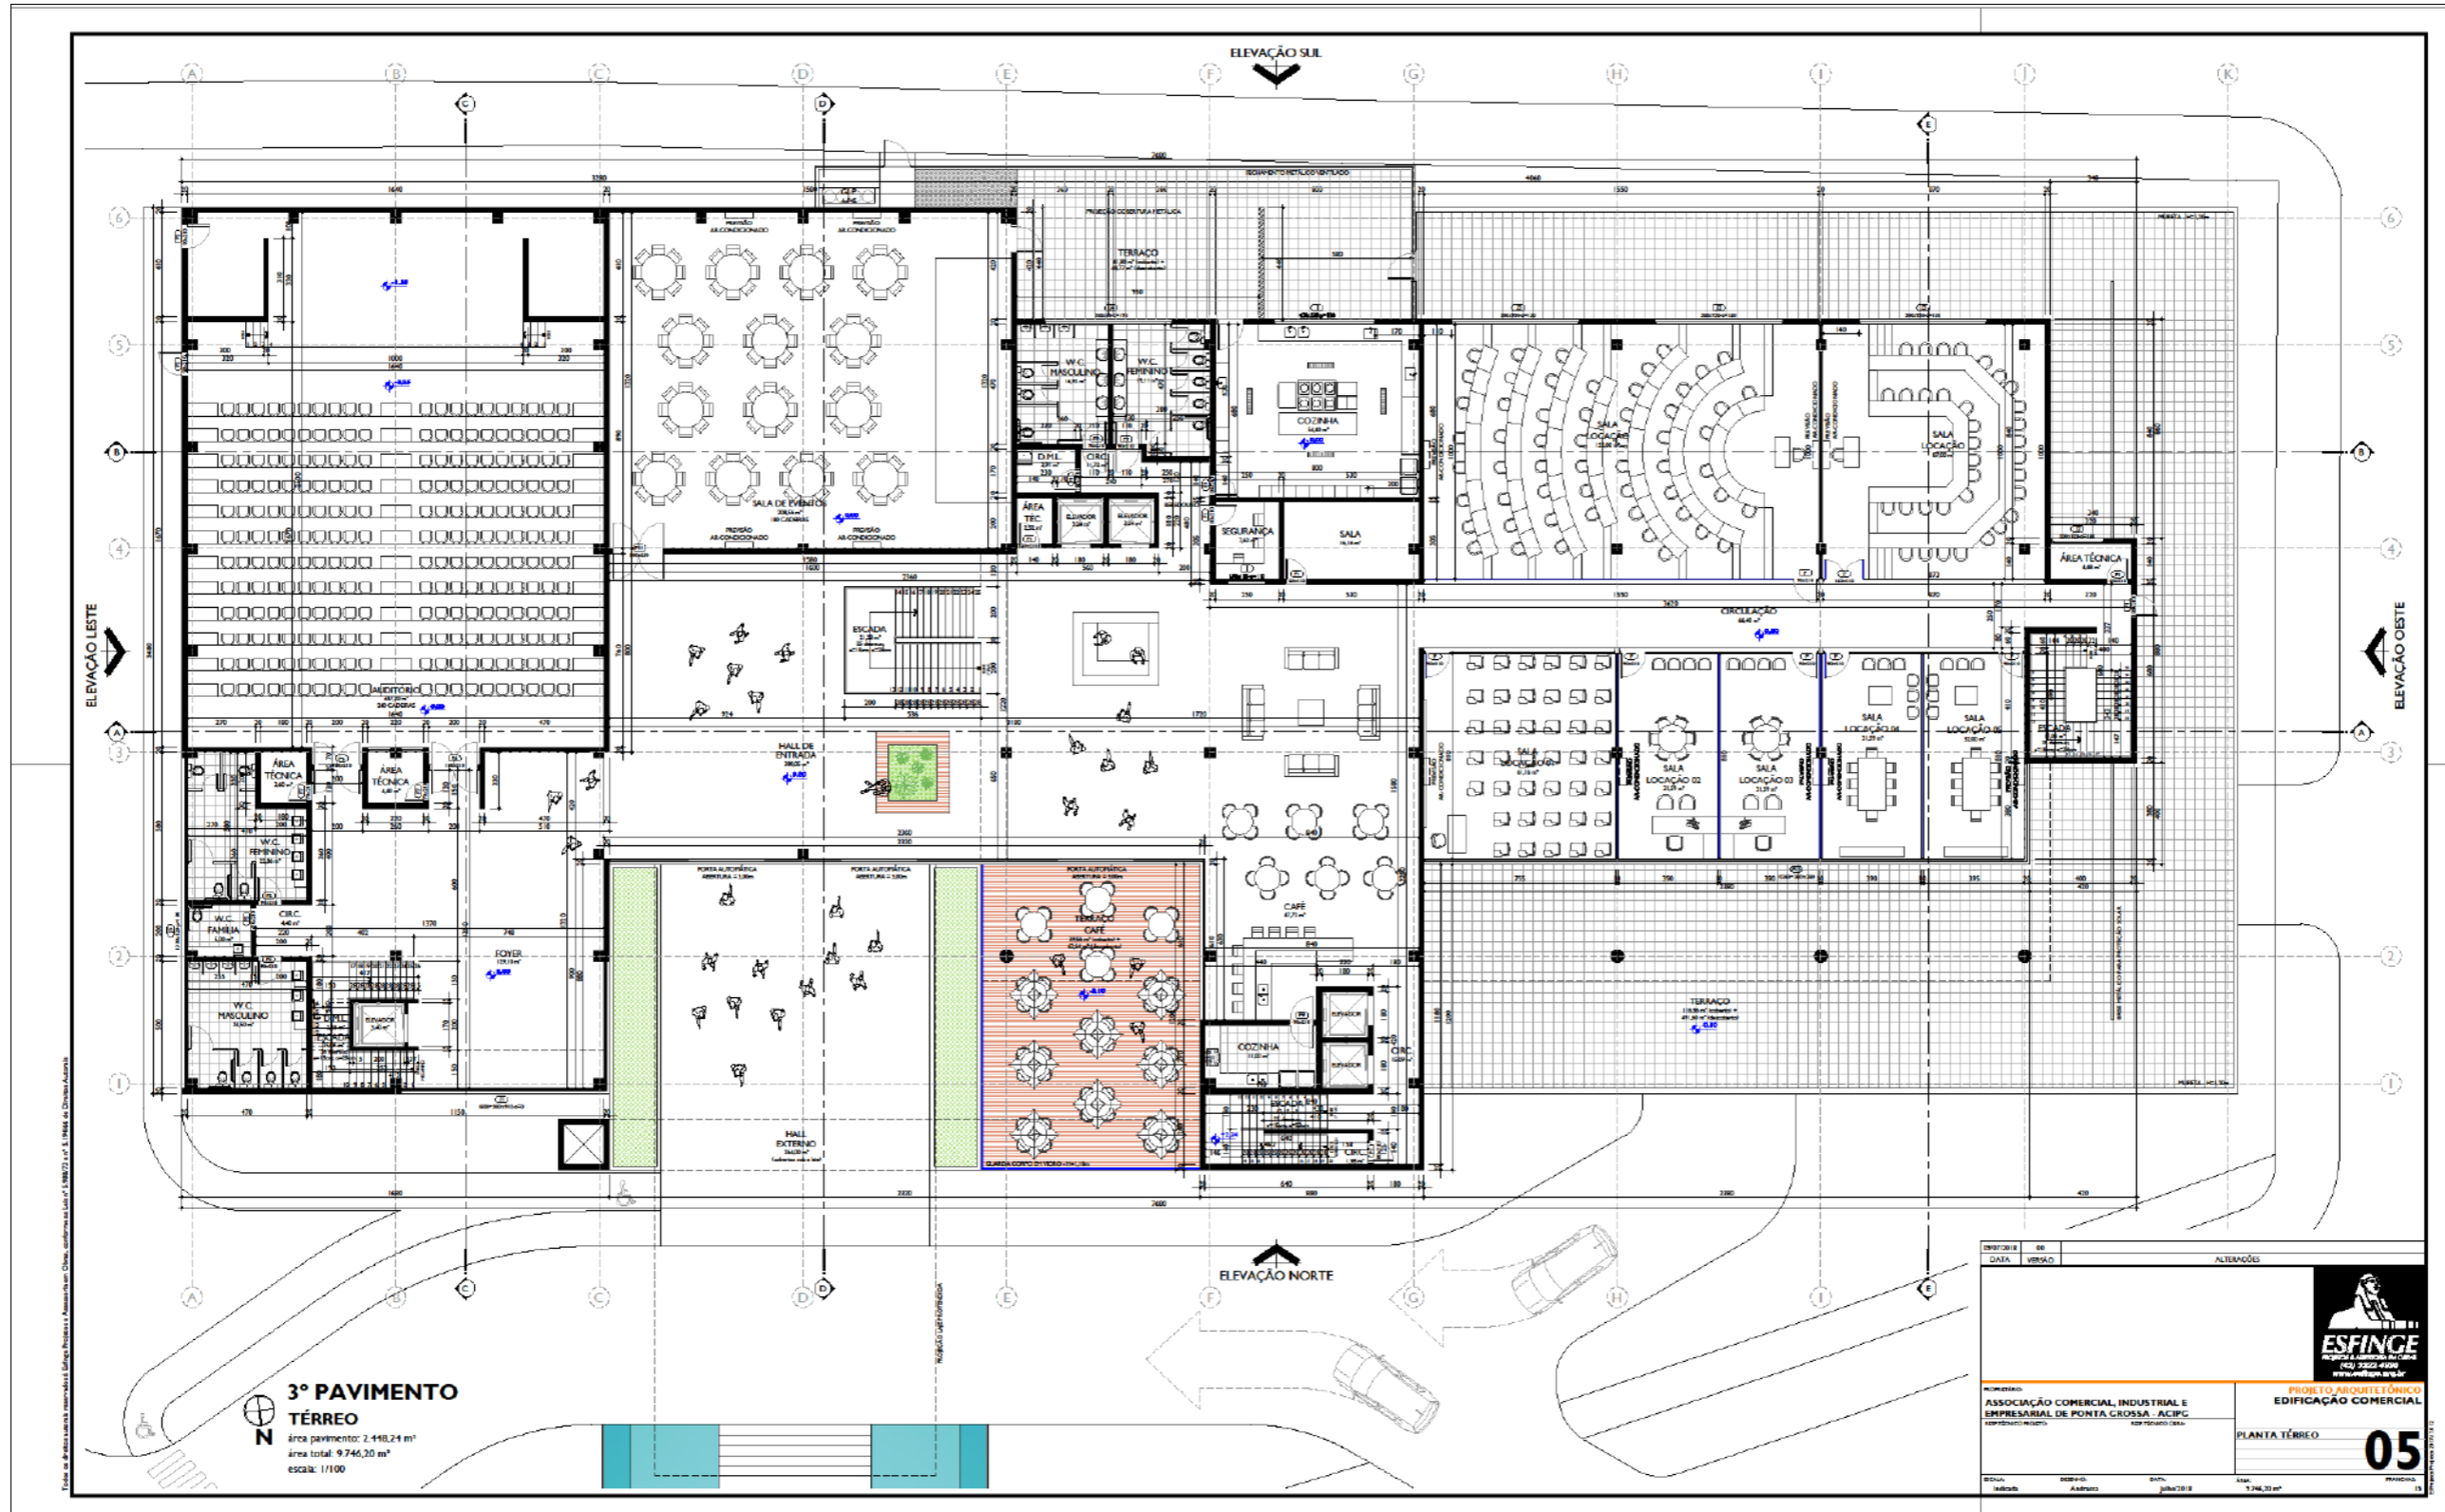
Planta térreo. Fonte: Esfinge Arquitetura e Engenharia (2018).
